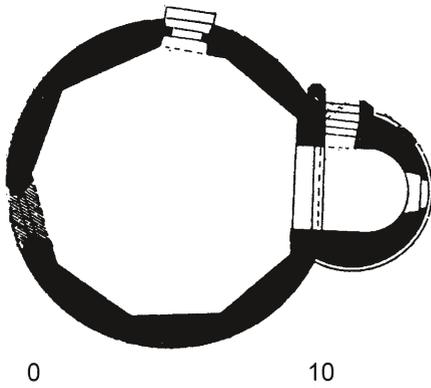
Lauf, Lkr. Berchtesgadener Land. Grundriss des Obergeschosses auf Bodenhöhe (nach Bezold/Riehl/Hager 1905a, 2705 [entnommen aus dem Gesamtgrundriss der Stiftskirche mit angefügtem Karner]).
